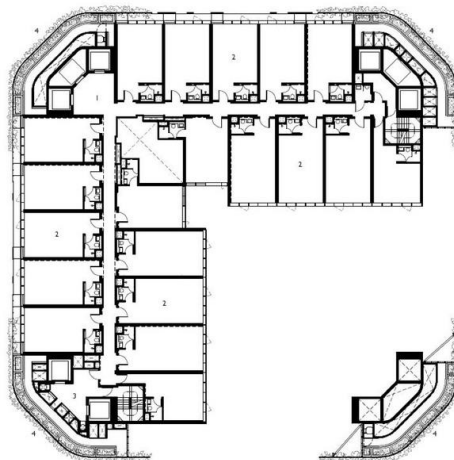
Denah Lantai 6 Oasia Hotel, Singapura
